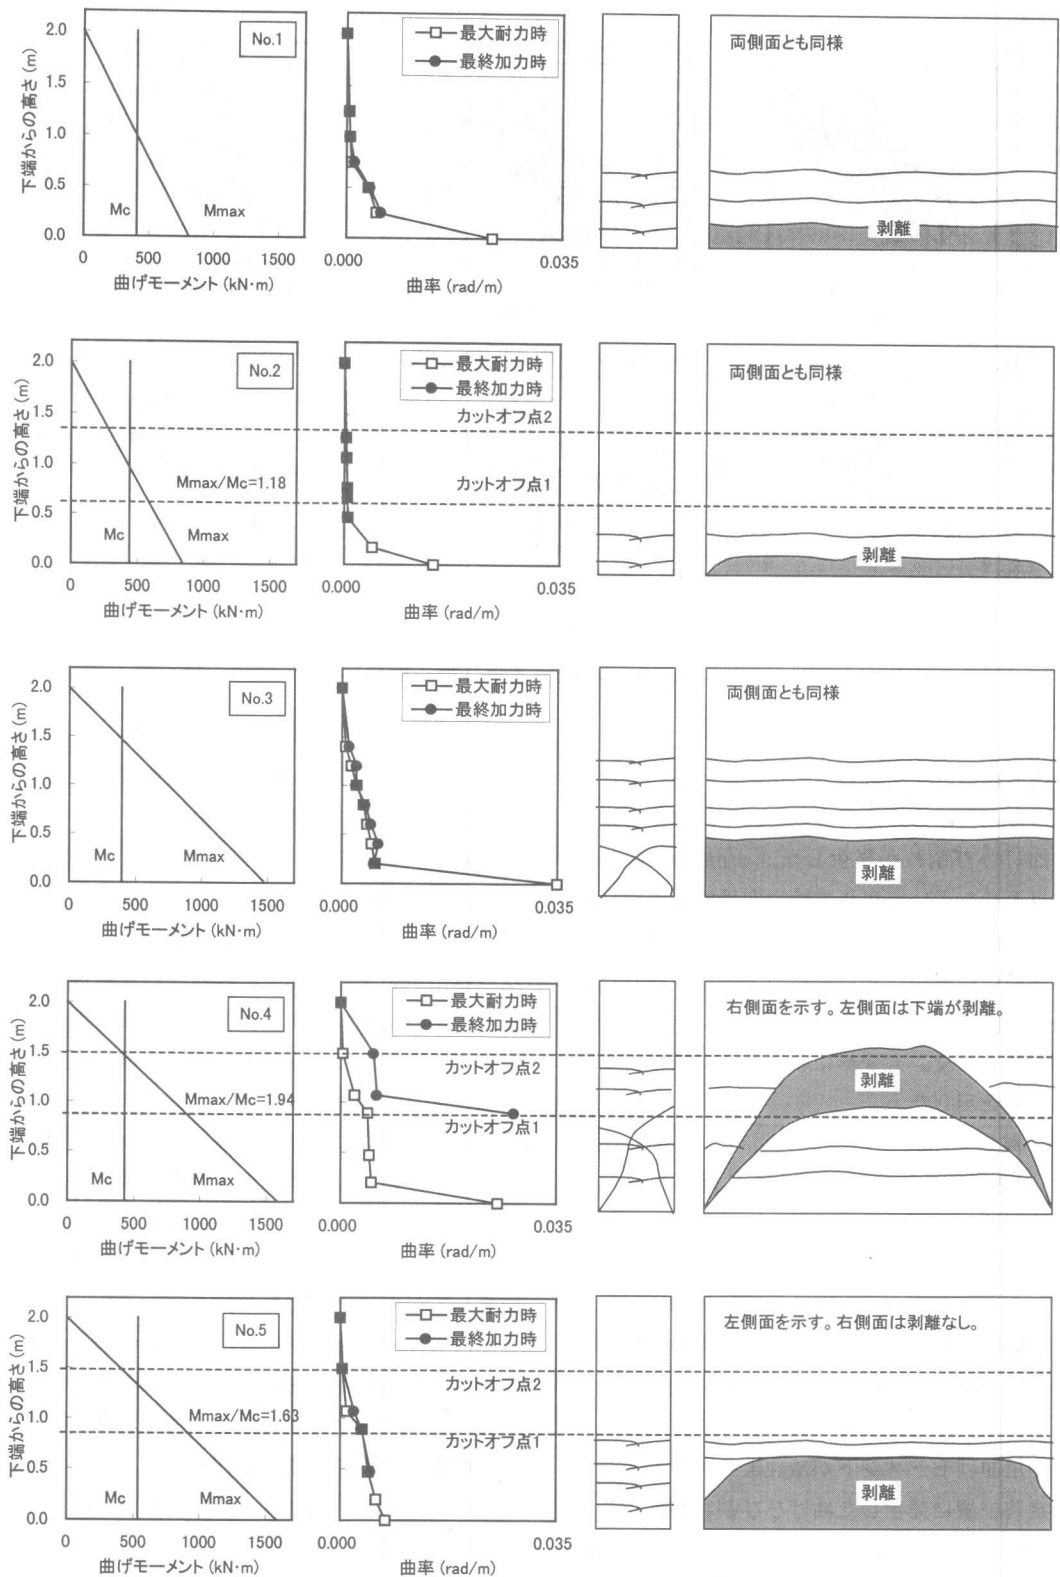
各試験体の曲げモーメント分布, 曲率分布, ひび割れ状況
